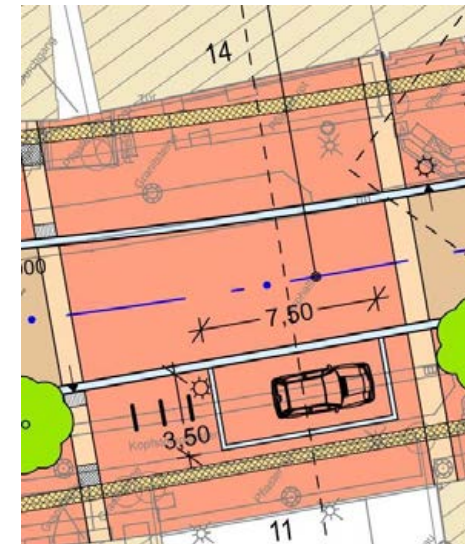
Grundmaße für Pkw-Parkstände
